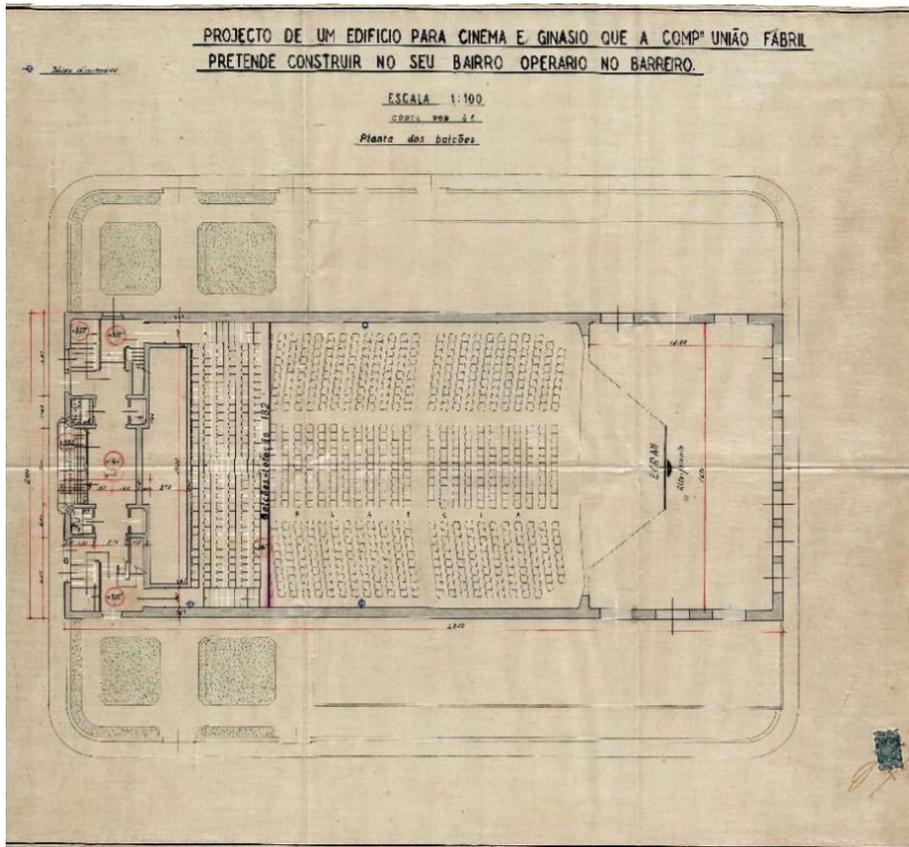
Planta dos balcões do Edifício para Cinema e Ginásio
